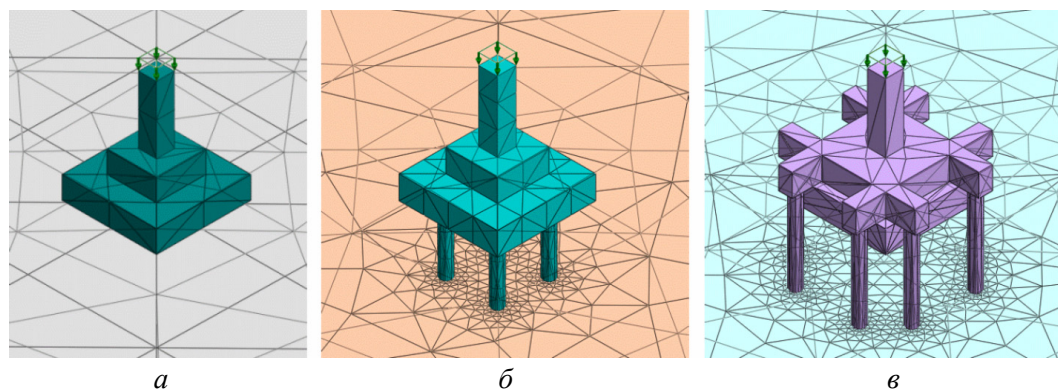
Расчетные схемы отдельно стоящего фундамента в ПК Midas GTS NX: а – до усиления; б – при устройстве свай под подошвой фундамента; в – при устройстве выносных (примыкающих) свай (верхний слой грунта, окружающий сваю и фундамент, отключен для визуализации)
